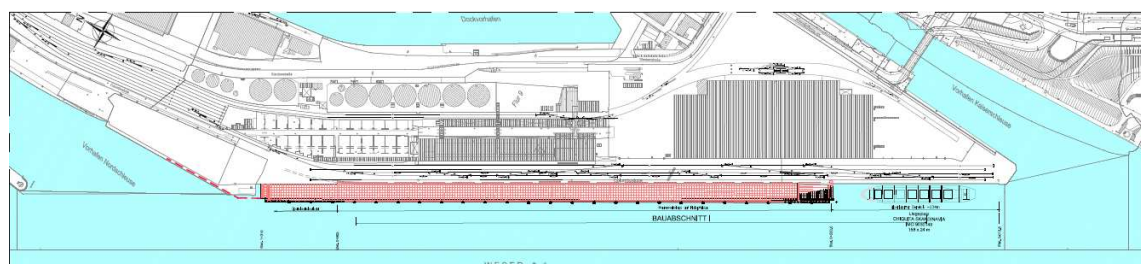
Lageplan Columbuskaje mit Sanierungsabschnitt
